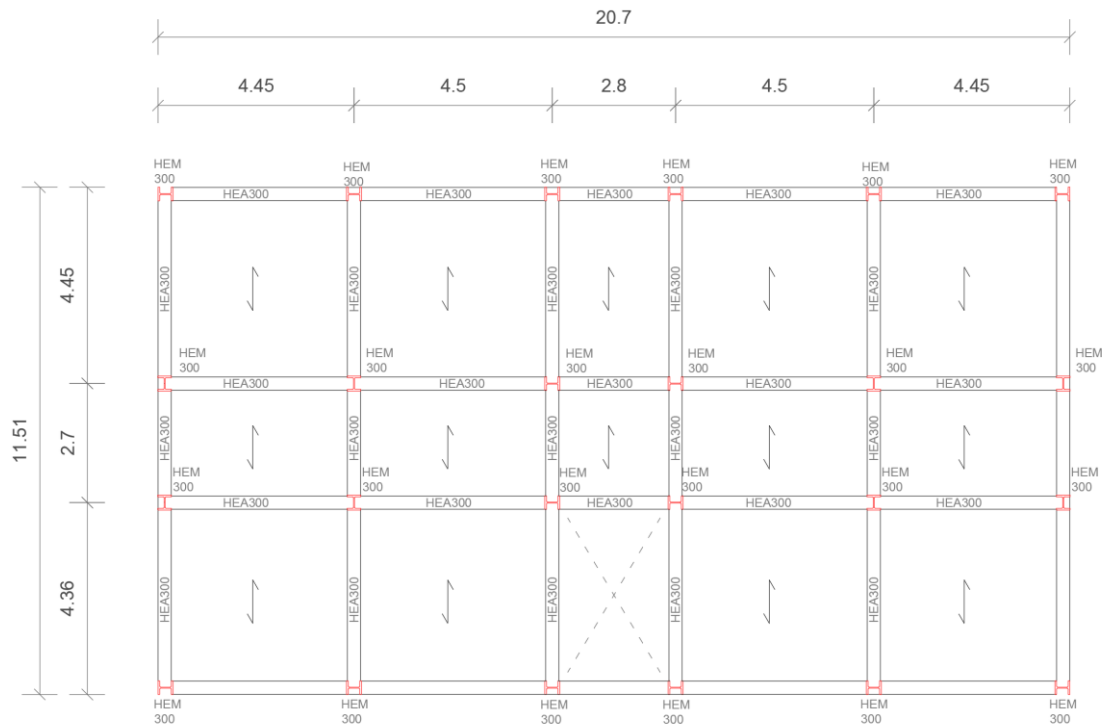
Carpenteria primo solaio struttura in acciaio a tre piani.
